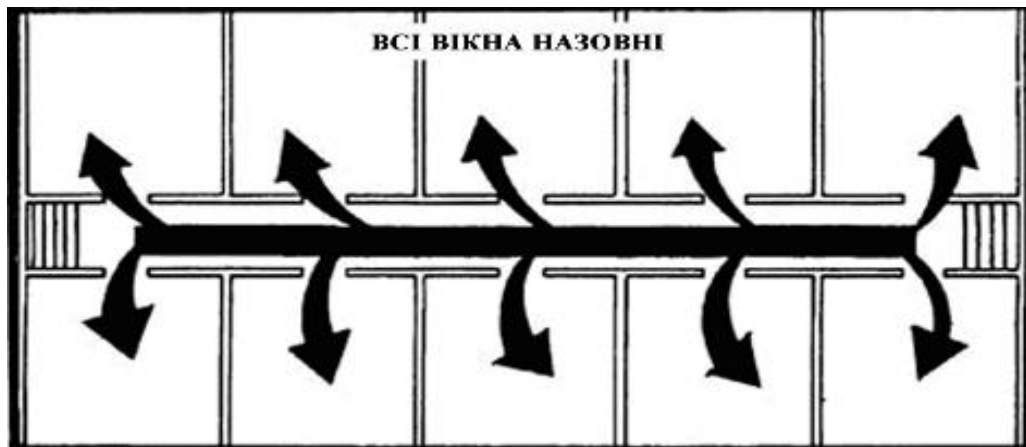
типовий план поверху будівлі з коробчастими стінами (варіант).
